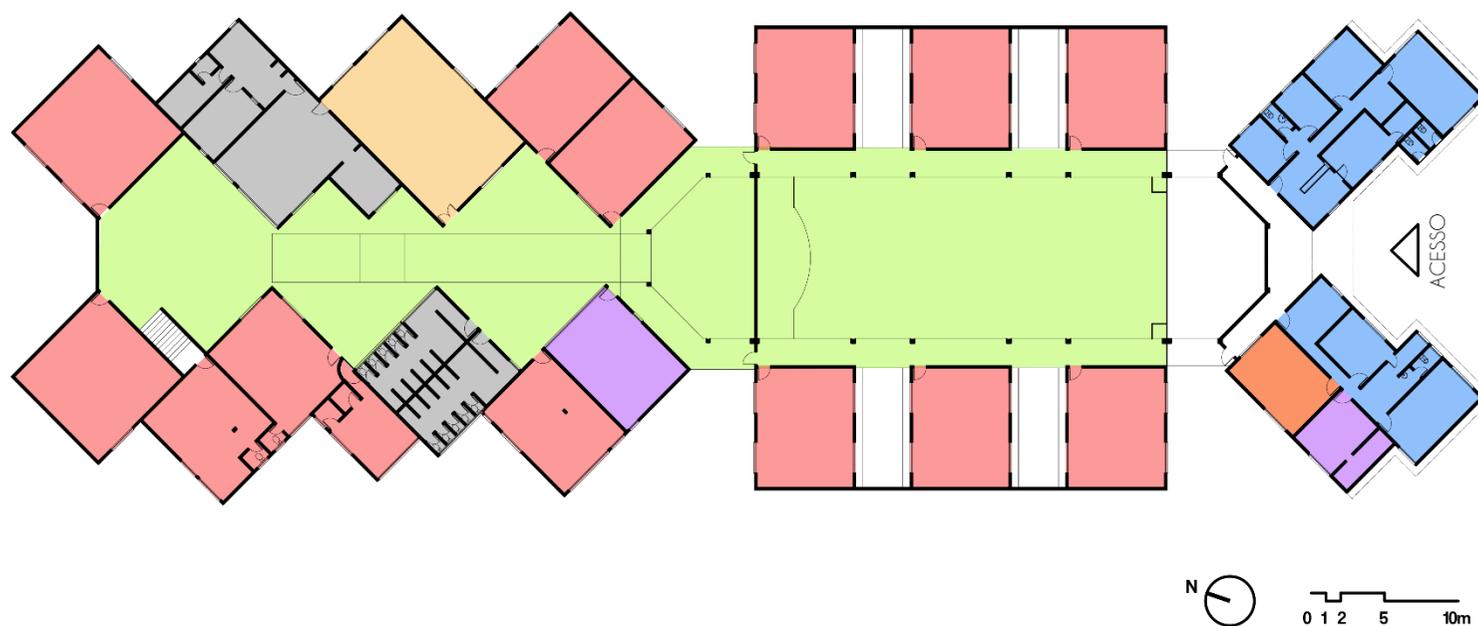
Planta baixa com zoneamento por cores do CEAI Elpidio de Almeida. Fonte: A autora.
